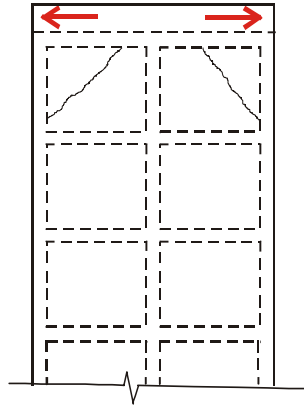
fissuras inclinadas em paredes por movimentação térmica da estrutura de concreto armado (DUARTE, 1998)
